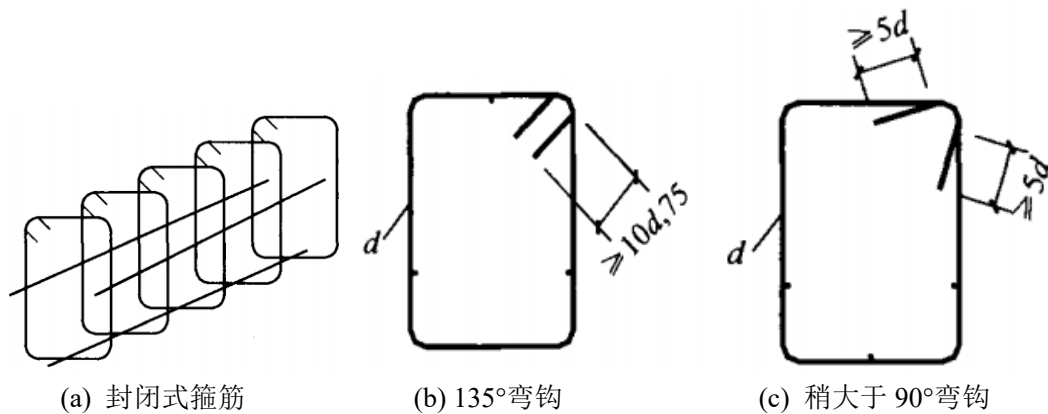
成型钢筋混凝土梁用穿箍成型钢筋
